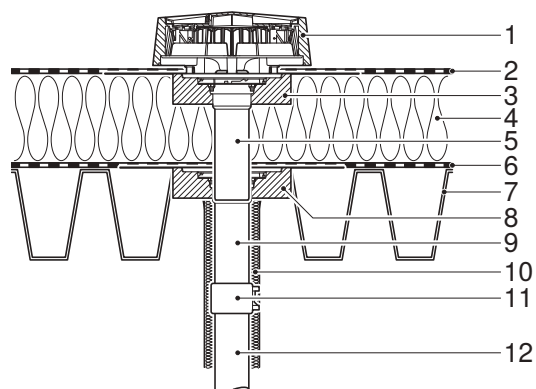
Montage dans toiture en bac d'acier isolée avec étanchéité de la toiture bitumineuse
